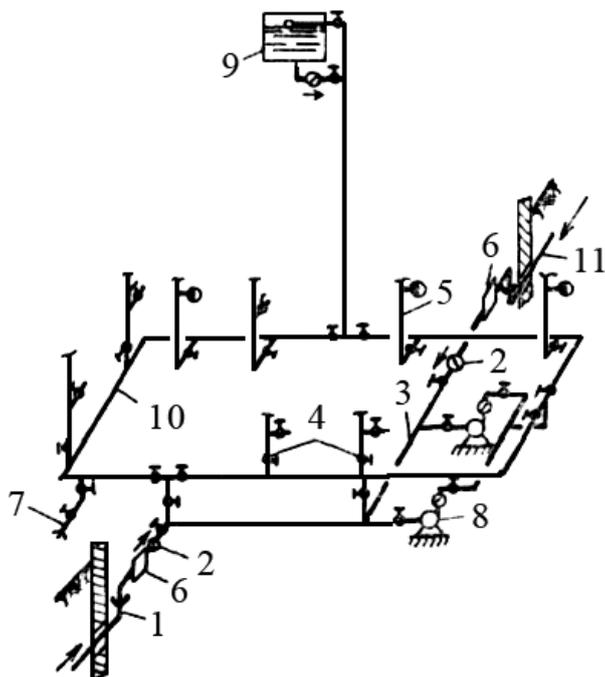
Система водоснабжения здания с водонапорным баком и повысительной насосной установкой: 1 – ввод № 1; 2 – обратный клапан; 3 – перемычка; 4 – запорная арматура; 5 – пожарный стояк; 6 – водомерный узел; 7 – поливочный кран; 8 – насосная установка; 9 – водонапорный бак; 10 – кольцевая магистраль; 11 – ввод № 2
